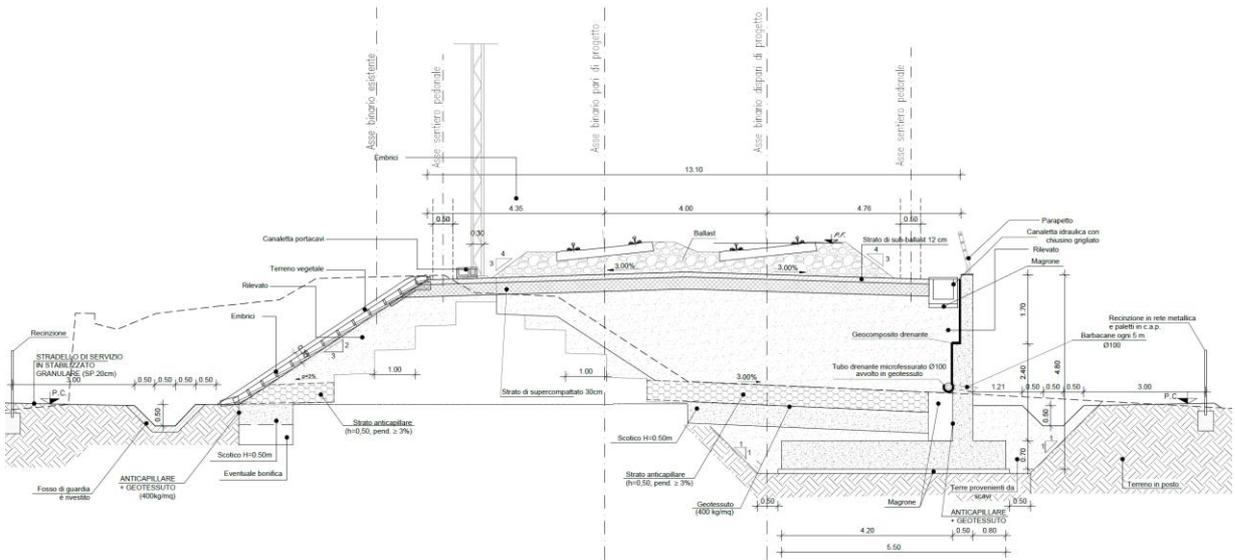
Muro di sostegno lato BD dal km 34+684.98 al km 34+755.03– sezione tipo
